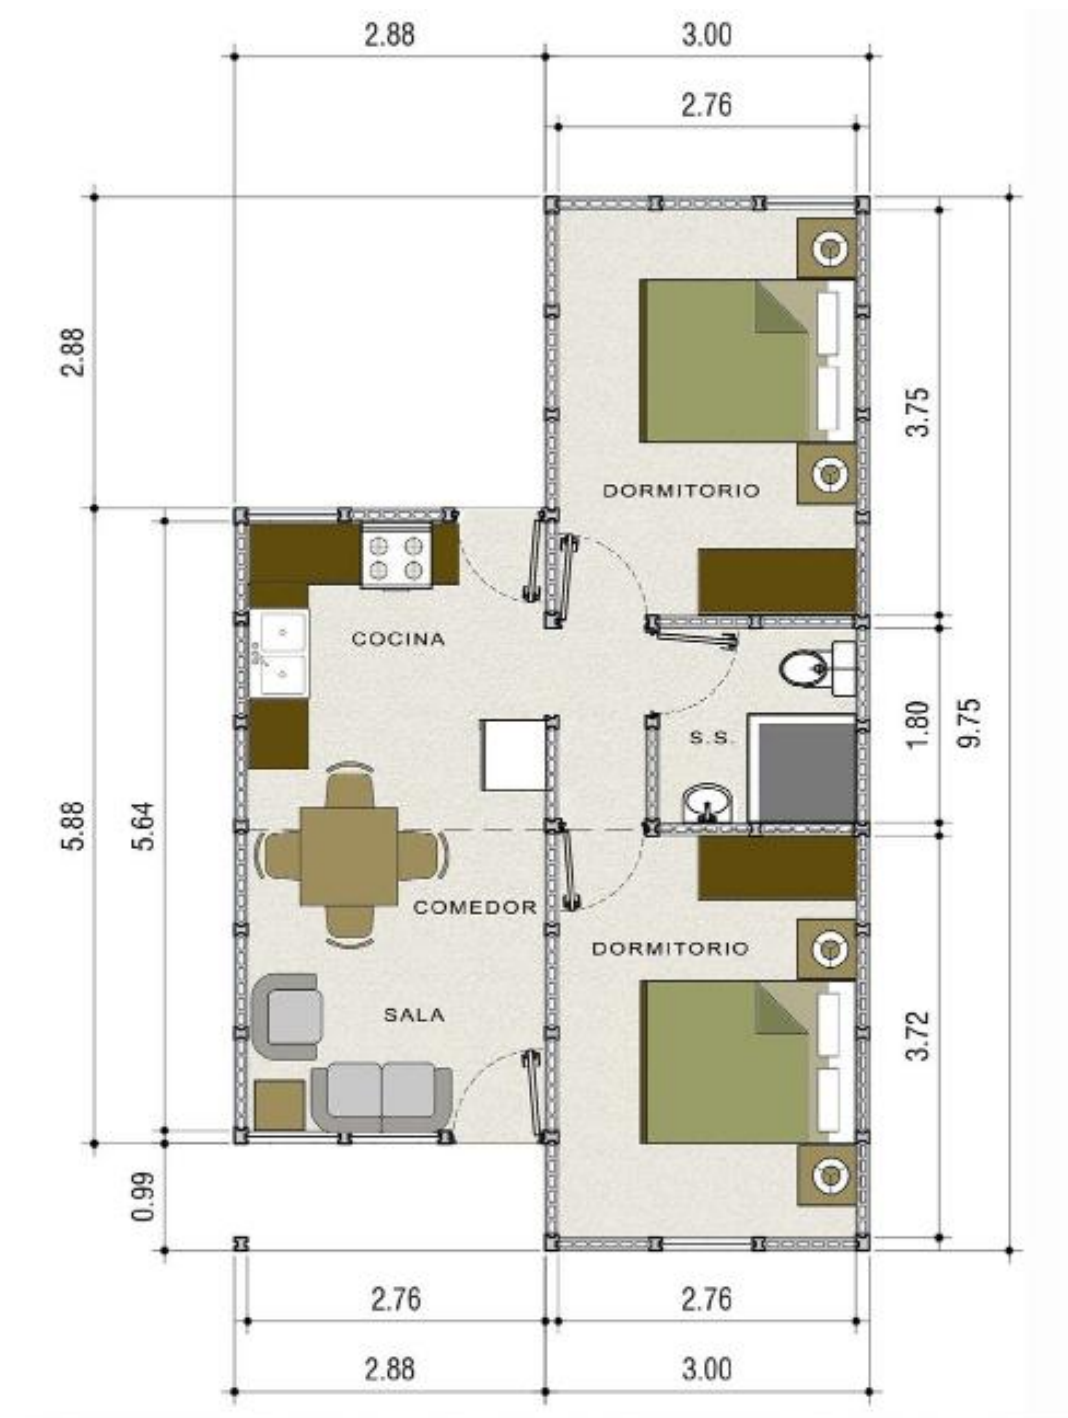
Arquitectura de los apartamentos 2ª planta.
